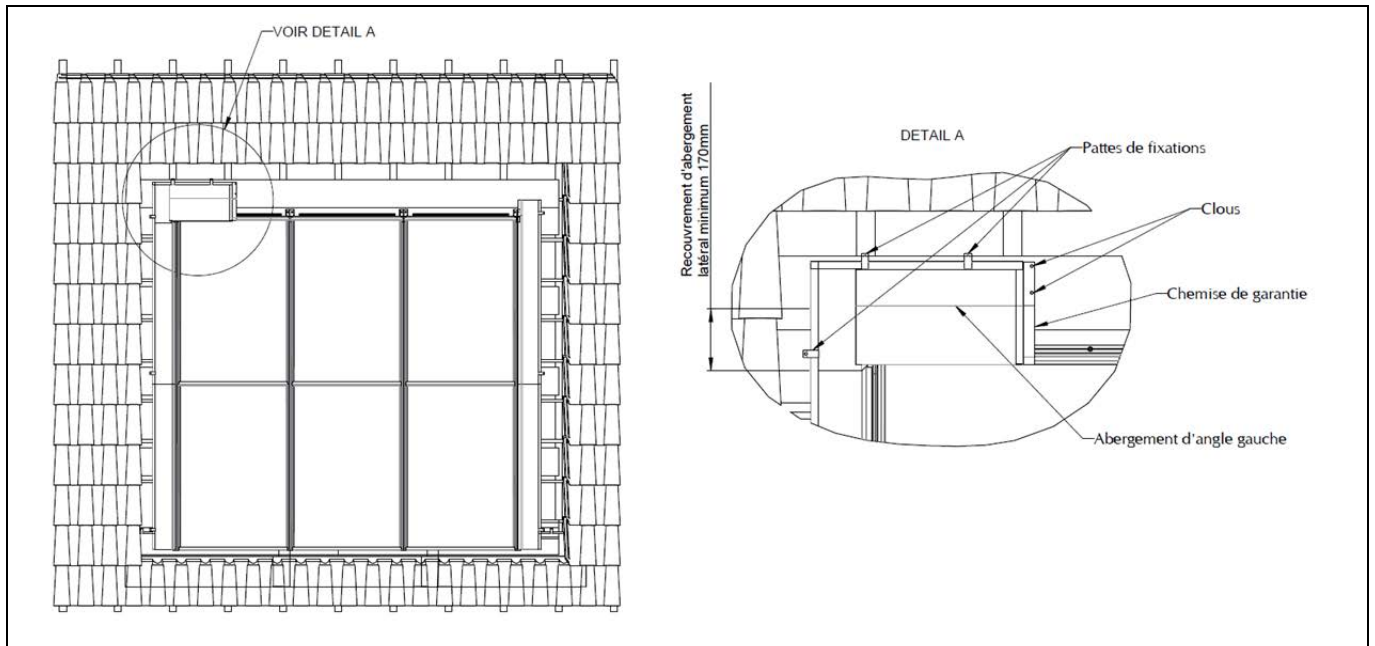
Pose de l'abergement supérieur gauche pour installation sur toiture tuile
